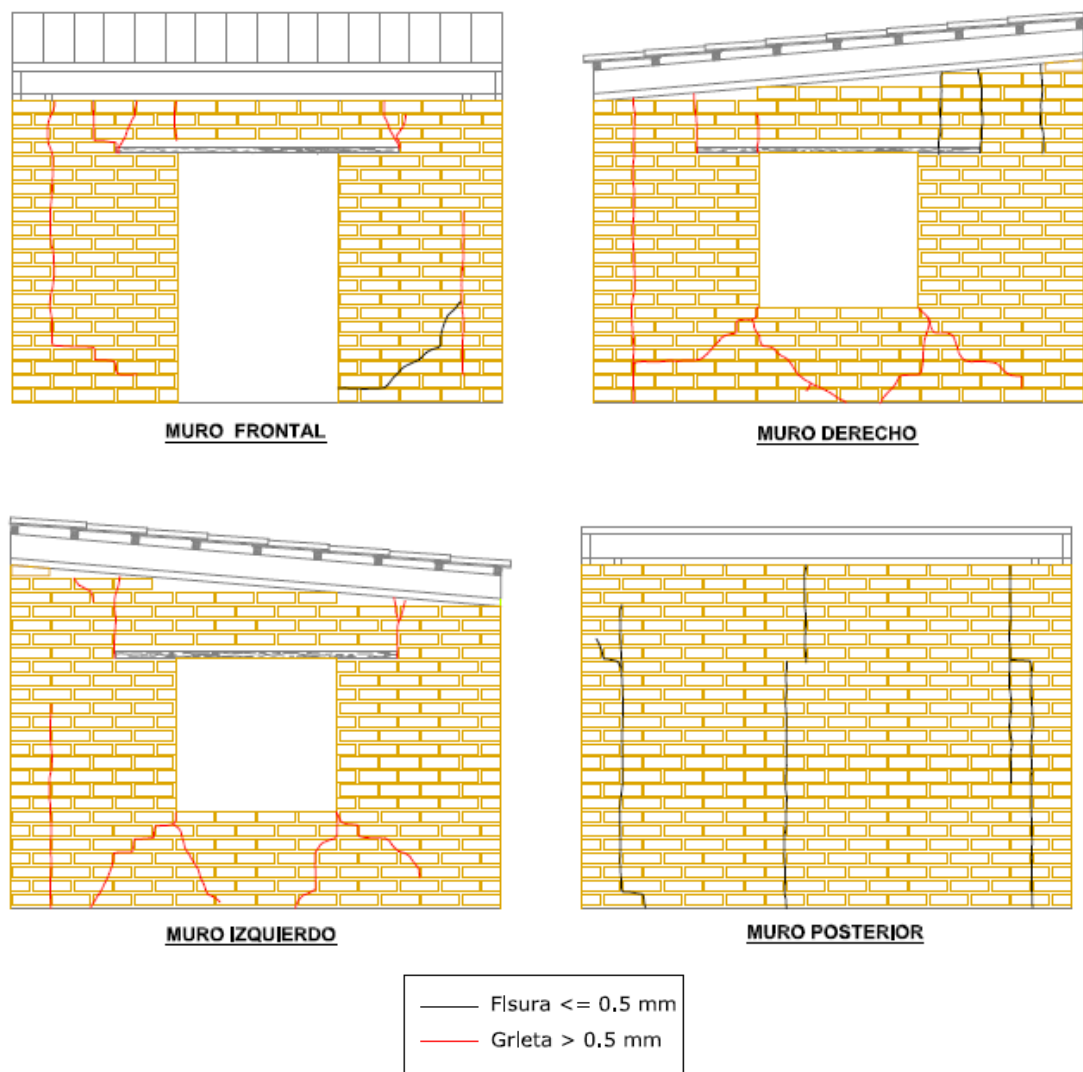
Fisuras y grietas exteriores en muros – Módulo M100-T4100D
